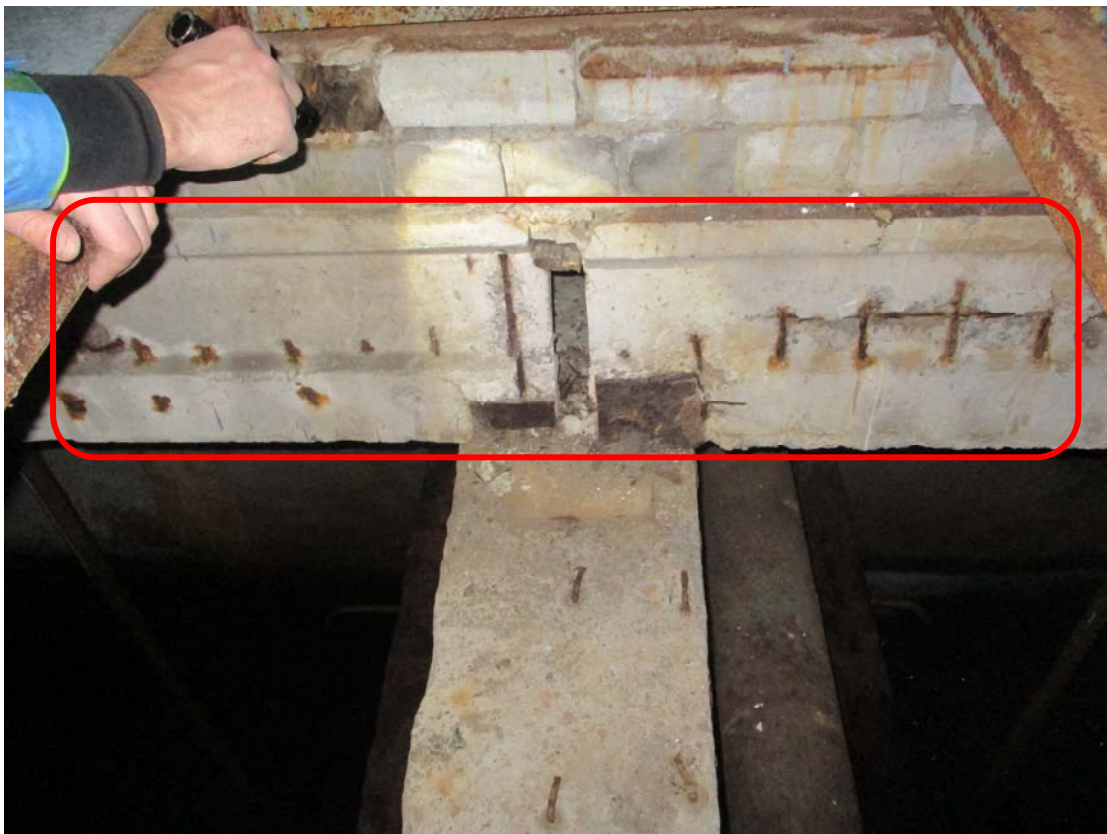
Разрушение защитного слоя бетона плит перекрытия блока емкостей с оголением и коррозией армирования.
